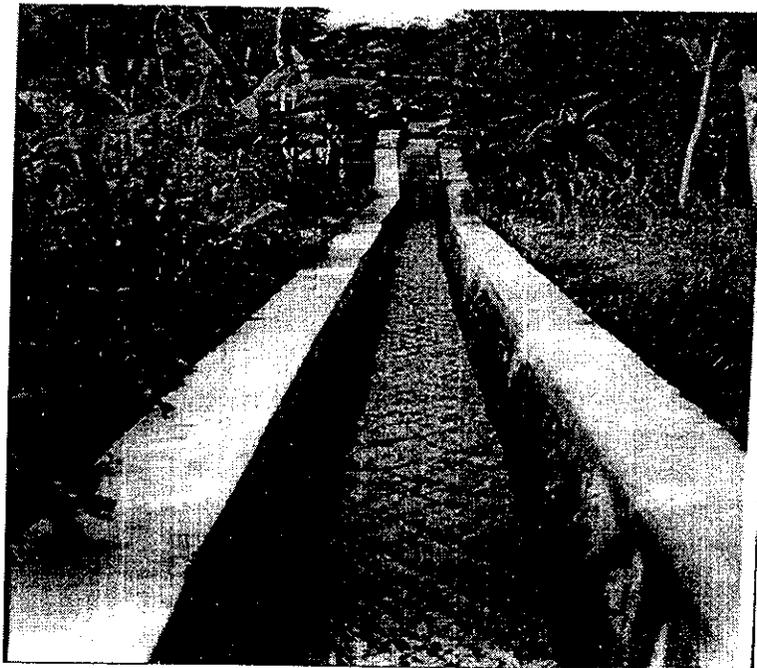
Vue du tronçon de canal construit sur le canal Jean David à Tavet
